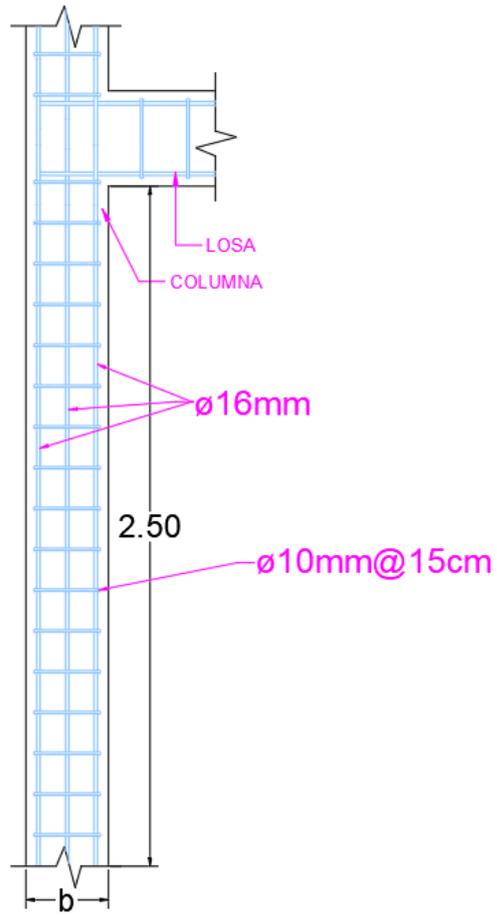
Detalle de columna en plano estructural [AutoCad]
